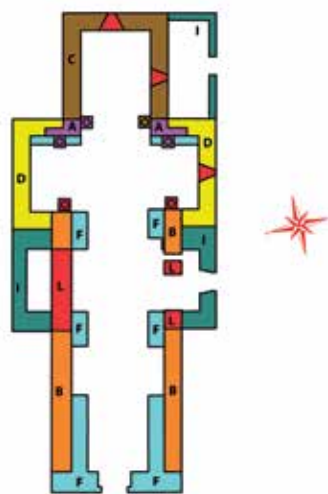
Planta. Estat anterior a la restauració de 1959-1962.
